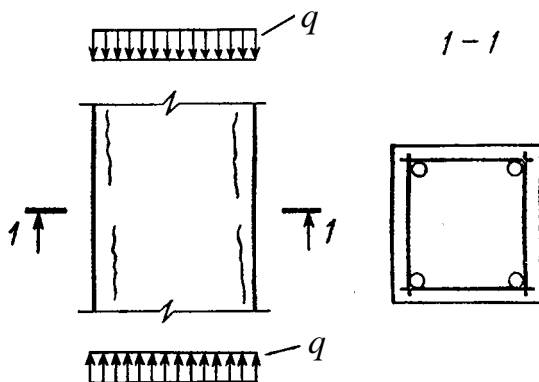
Трещины вдоль продольной арматуры в сжатых элементах
